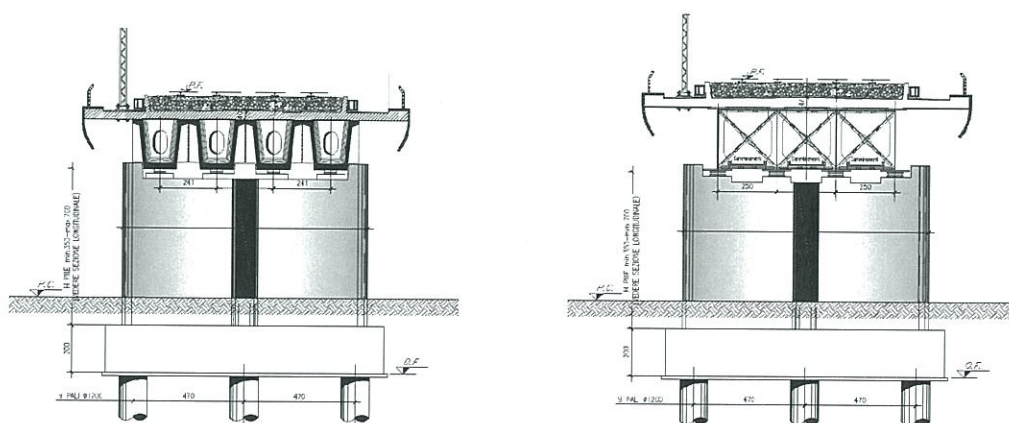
Pila campate 25 - 40 m: viste trasversali
